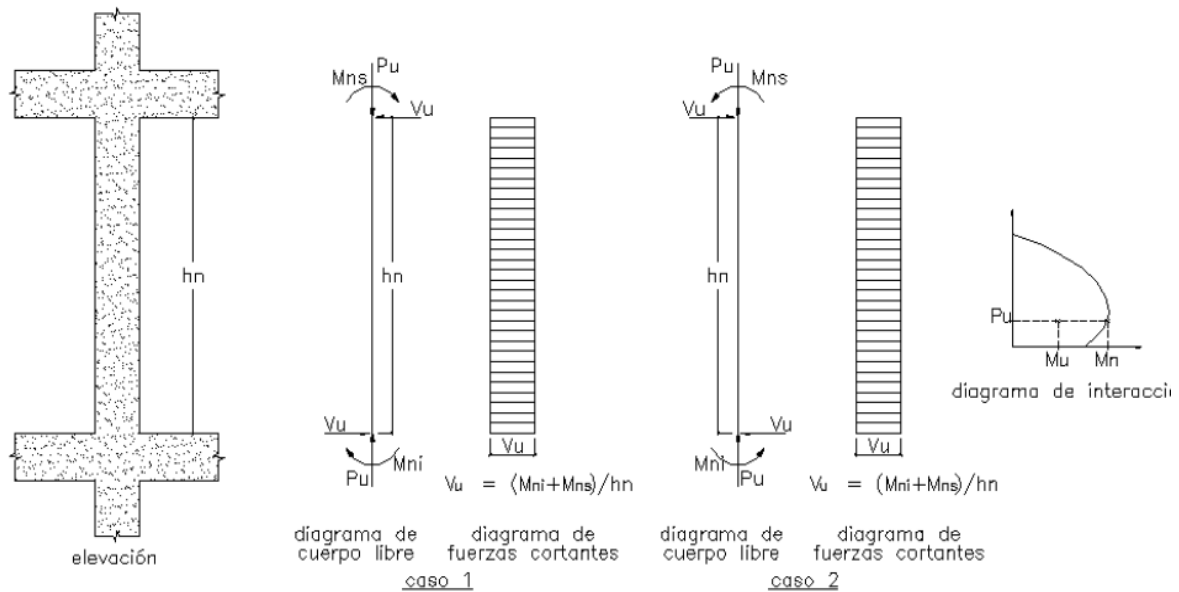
Fuerza cortante de diseño en columnas
